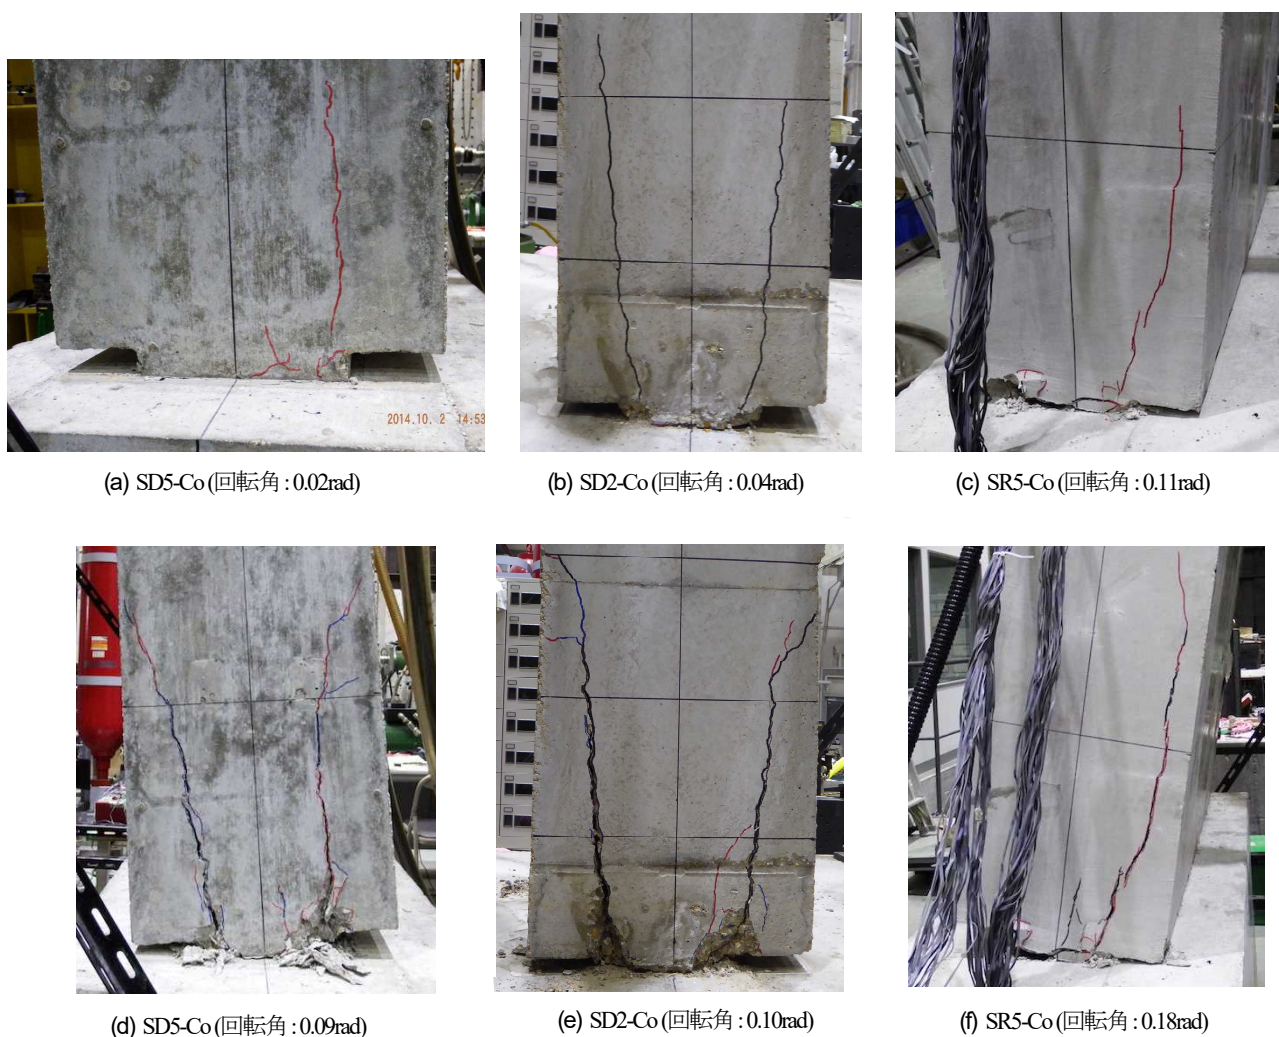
ヒンジ部コンクリートから発生した縦方向のひび割れとそのときのヒンジ部の回転角
